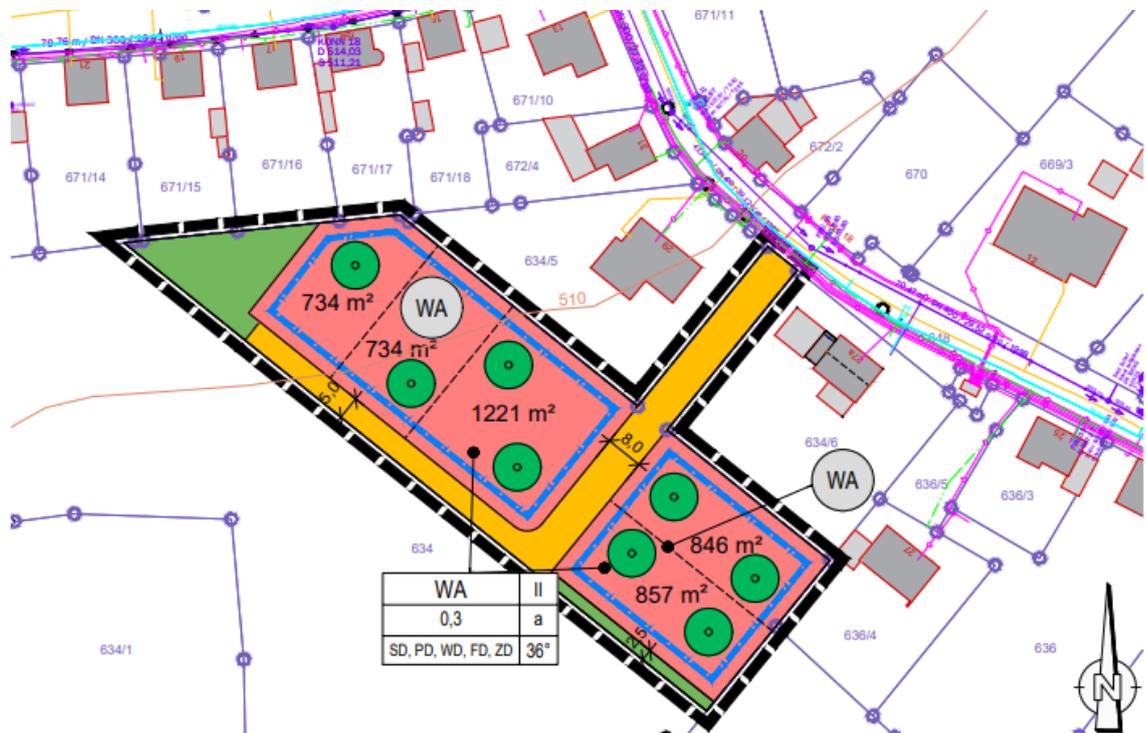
Darstellung des Bebauungsplans "Nähe Finkenbühlstraße"
